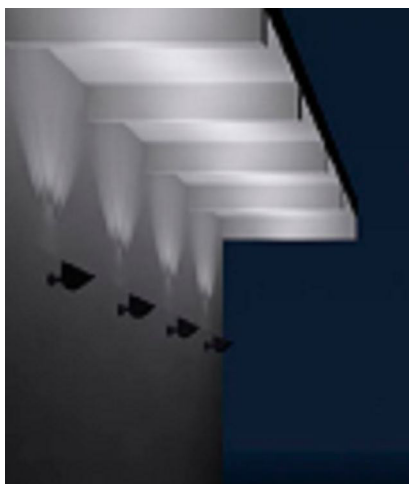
Esempio di illuminazione di porzioni di soffitto e travature realizzata con proiettori da esterno installati a parete (fonte ERCO)
